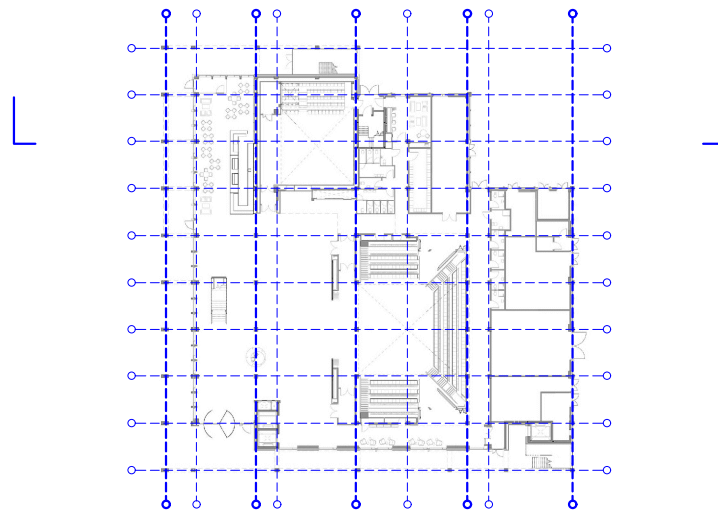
Planta baja del Town House de la Universidad de Kingston.
